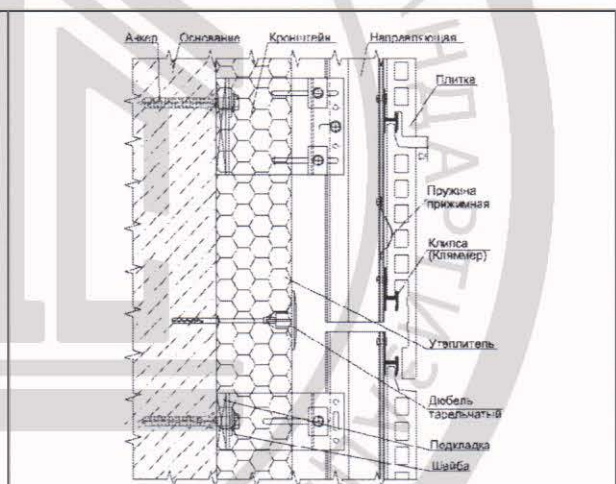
Облицовка – керамические плиты. Вертикальное сечение
